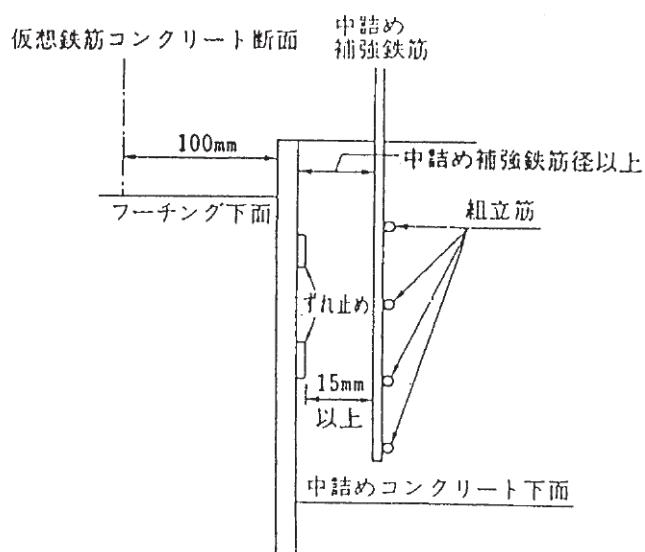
方法Bの構造詳細図（鋼管杭）
